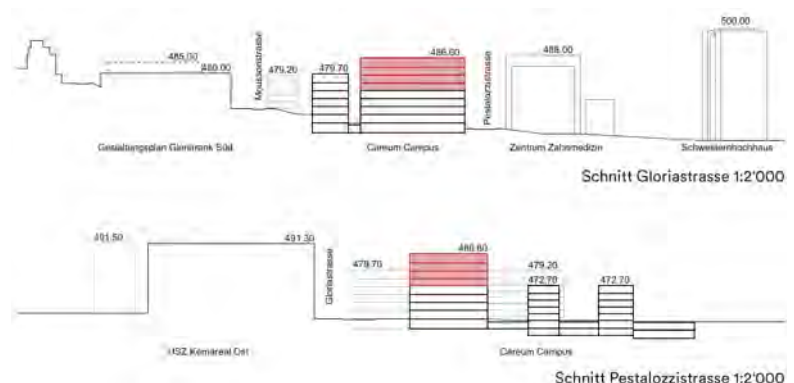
Aufstockung Hauptgebäude C1, Schnitte, Konzept Architektur und Städtebau von Bhend & Schläuri Architekten (vgl. Anhang A2)
